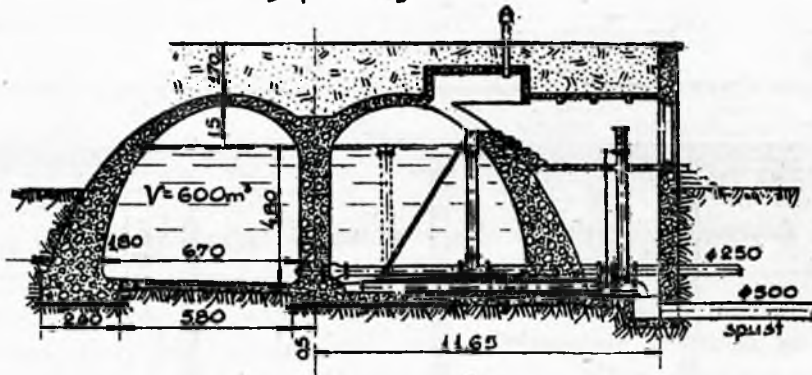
Projektowany zbiornik żelbetowy dla Krosna.
